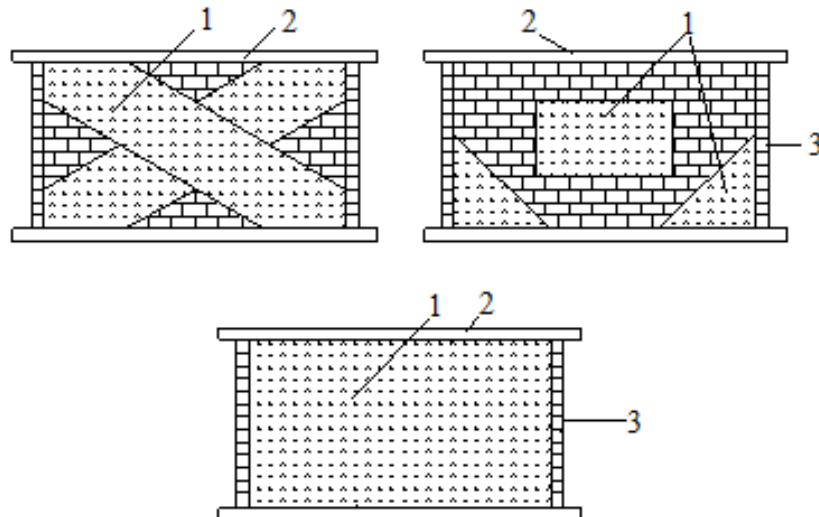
Армирование сетками из композитных материалов стен каменного здания, подверженного сейсмическим воздействиям [37]
